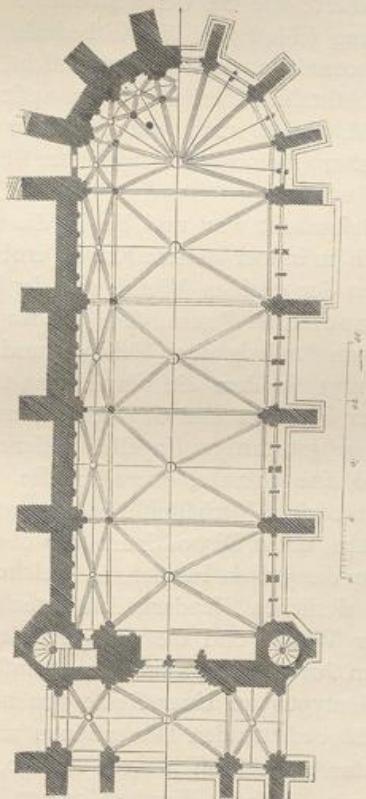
Ste. Chapelle zu Paris. Grundriss.
